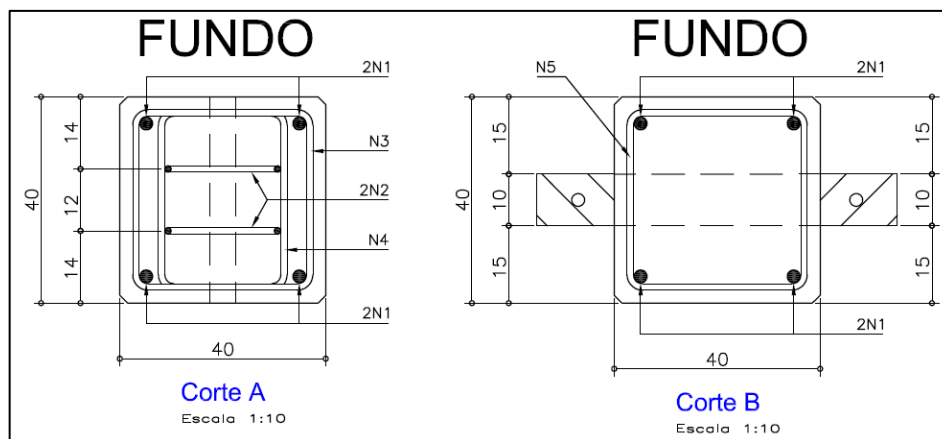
Detalhamento do pilar (medidas em centímetros).
